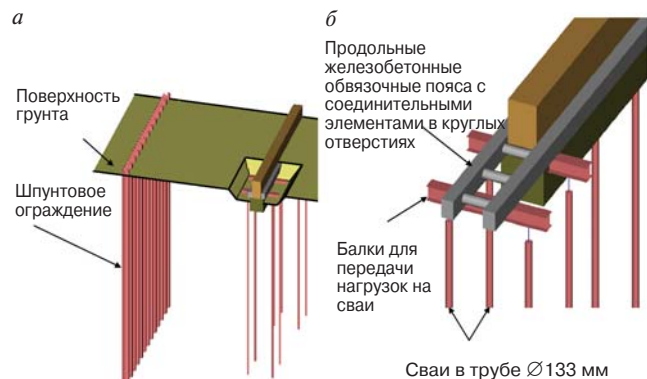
Устройство шпунтового ограждения (а) и узла передачи нагрузки от стен на буронабивные сваи (б)
